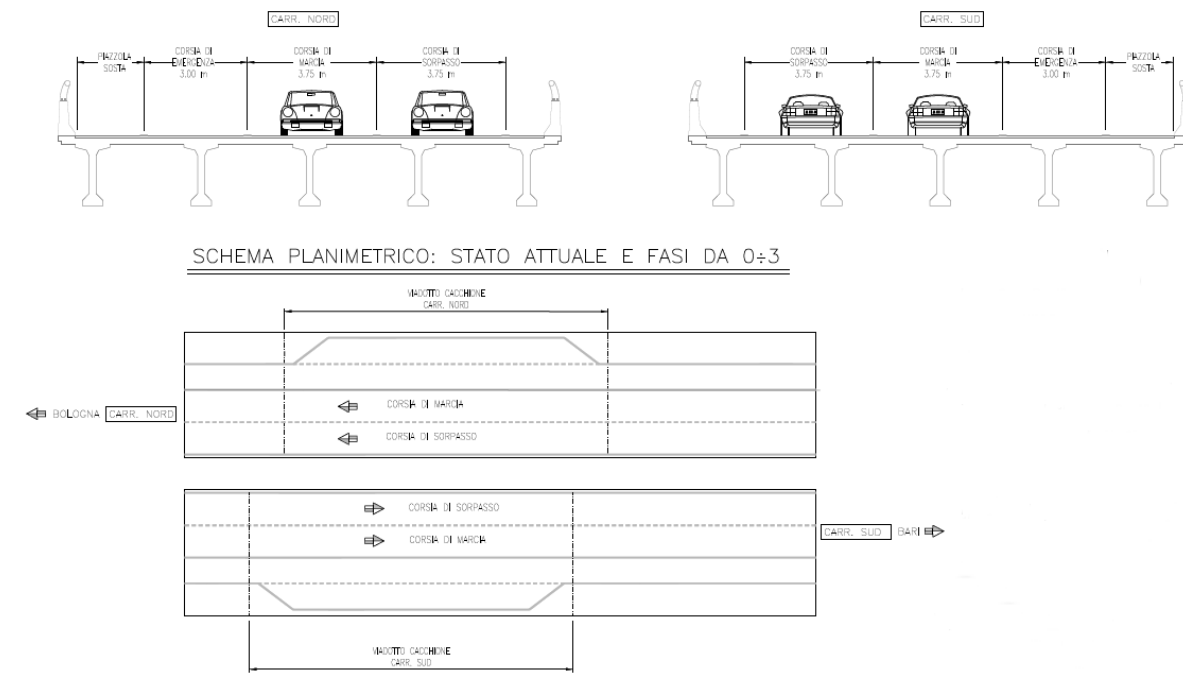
Sezione trasversale e schema planimetrico - Stato attuale e fasi da 0 a 3
